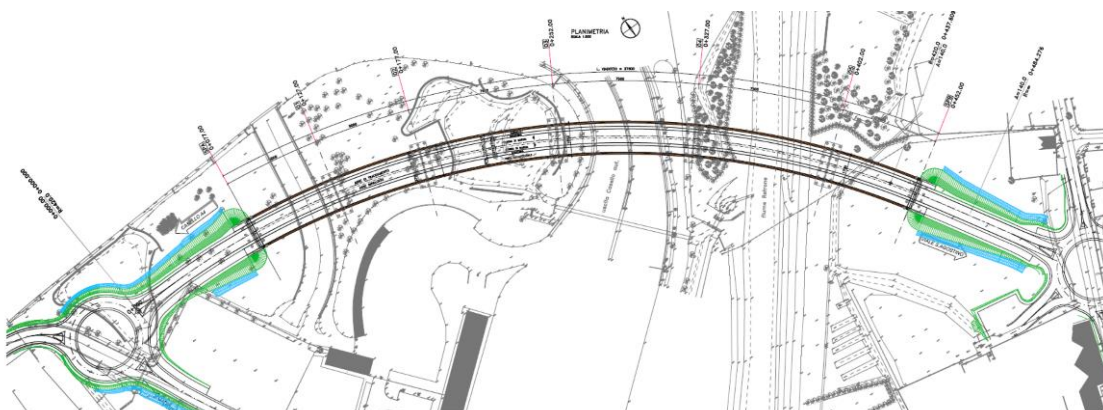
Ponte sul F.Retrone – Inquadramento planimetrico
